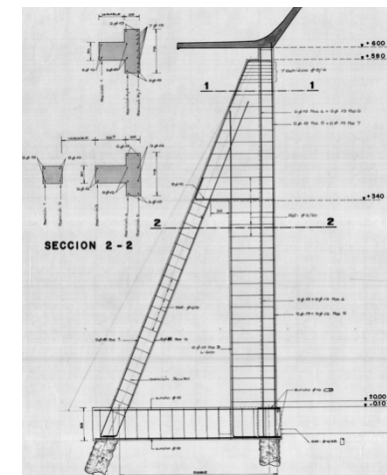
| Pilar tipo 3 en la fase 1 y 2.
